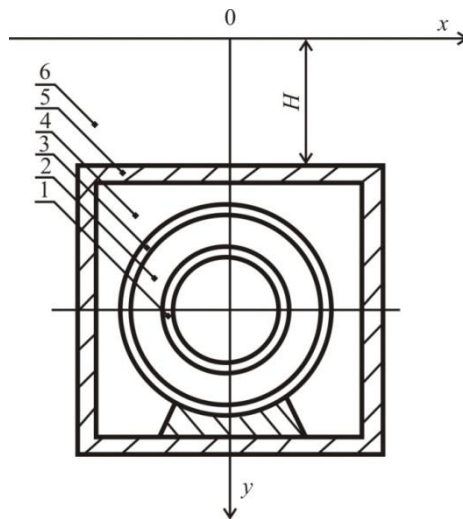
Однотрубный подземный канальный теплопровод: 1 – металлическая стенка трубы; 2 – слой тепловой изоляции; 3 – покровный слой; 4 – полость канала; 5 – железобетонная стенка канала; 6 – грунт
